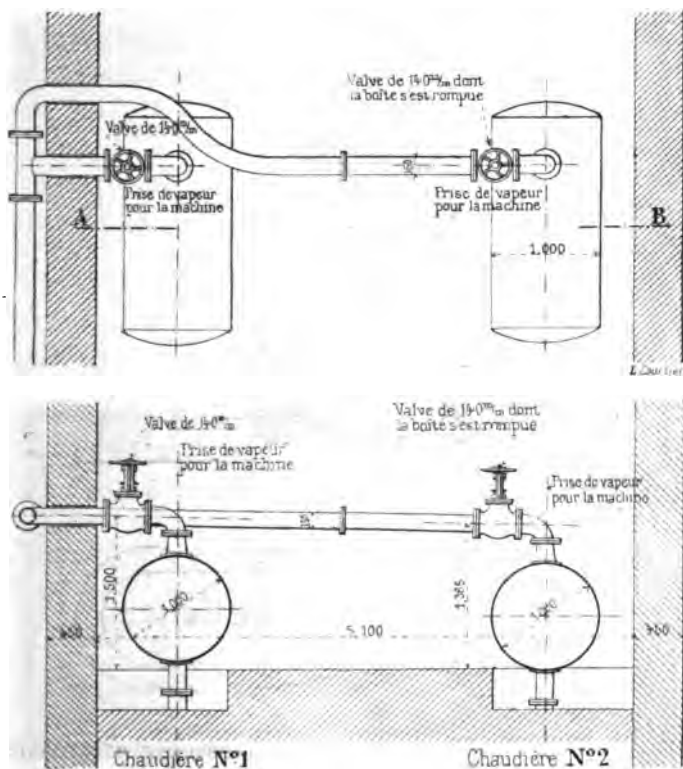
et 10. — Coupe et plan de l'installation, à Wervicq.
